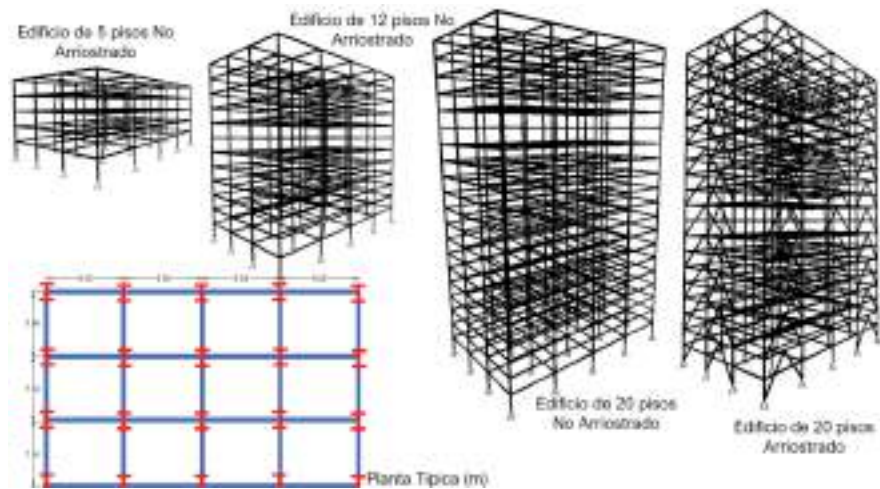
Esquemas estructurales y planta típica de las estructuras estudiadas, (Adaptado de García, 1996)
